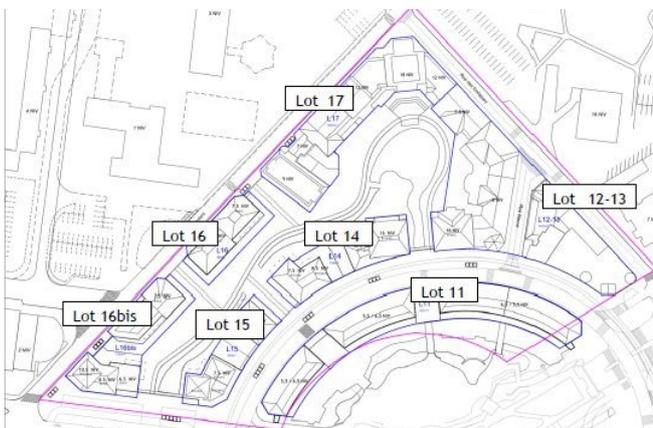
Plan général d'aménagement (étude d'impact p.26)
